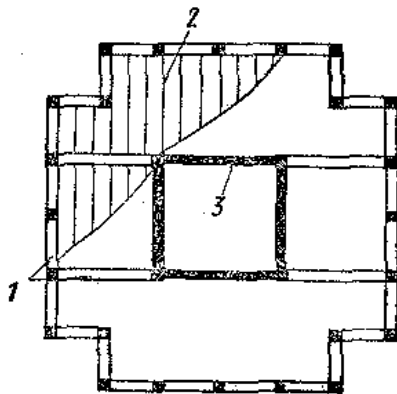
Конструктивный план многоэтажного каркасного здания с центральным ядром жесткости
